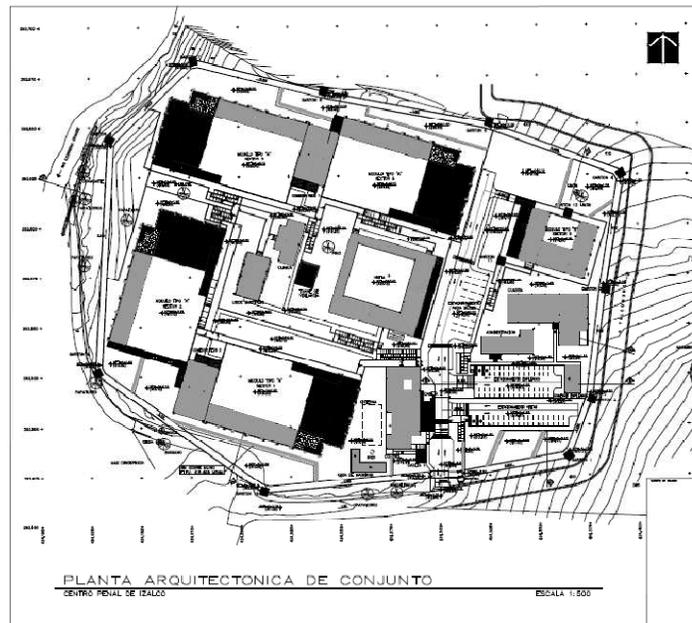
Planta de Conjunto y Techos del Comp. Penit. Izalco Fase 1, según diseño de 2005
